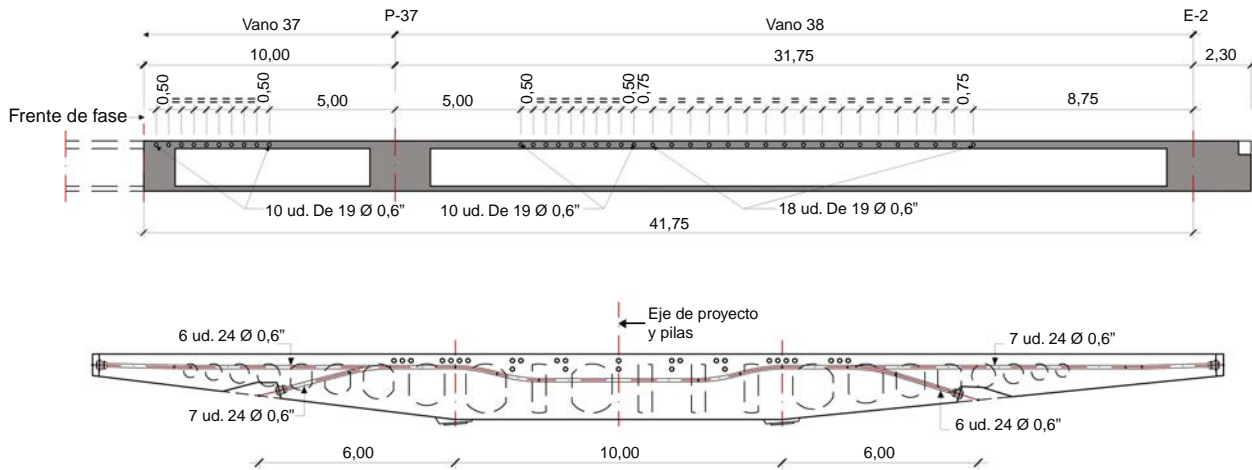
Disposición del pretensado transversal en vano lateral (sup) y pretensado en riostra de pilas 36 y 37 (inf).
